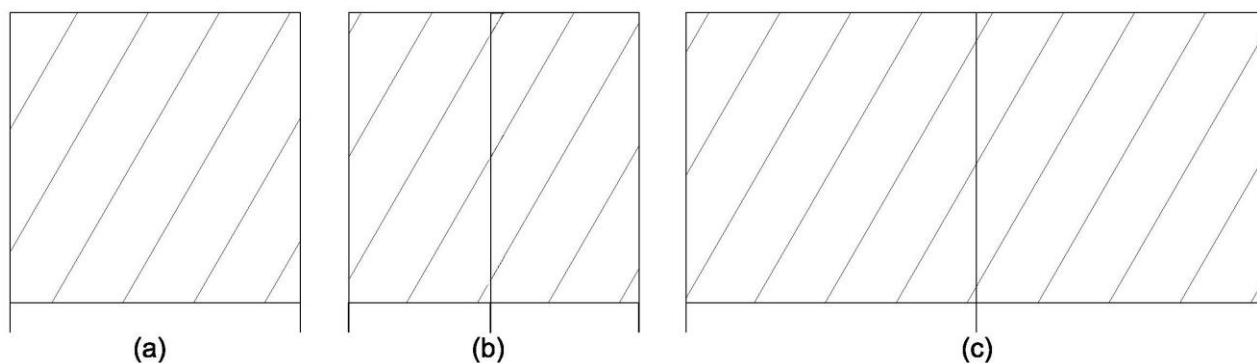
Schematizzazione in MatLab delle Wall A (a), Wall B (b) e Wall C (c)
